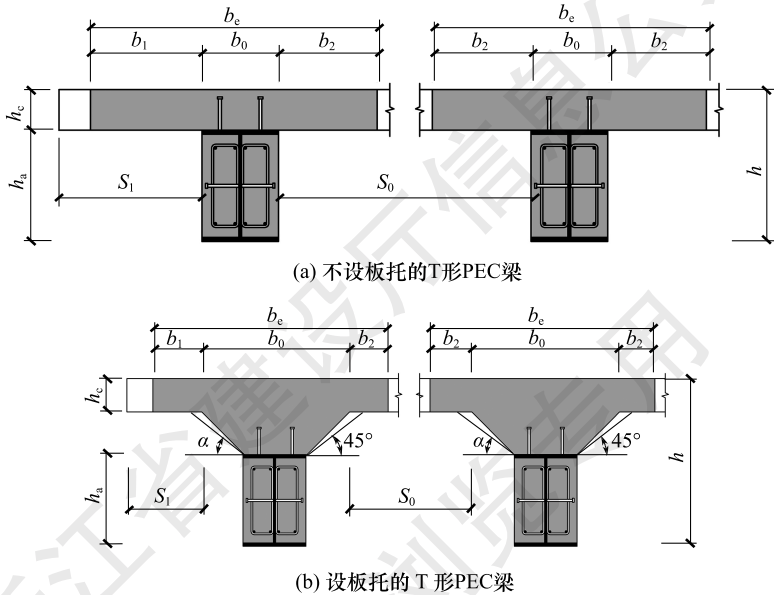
T 形 PEC 梁混凝土翼板的有效宽度
